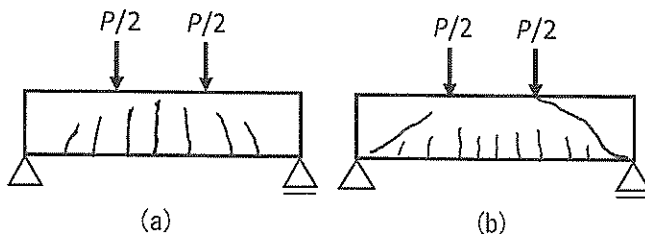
鉄筋コンクリート単筋梁のひび割れの様子
